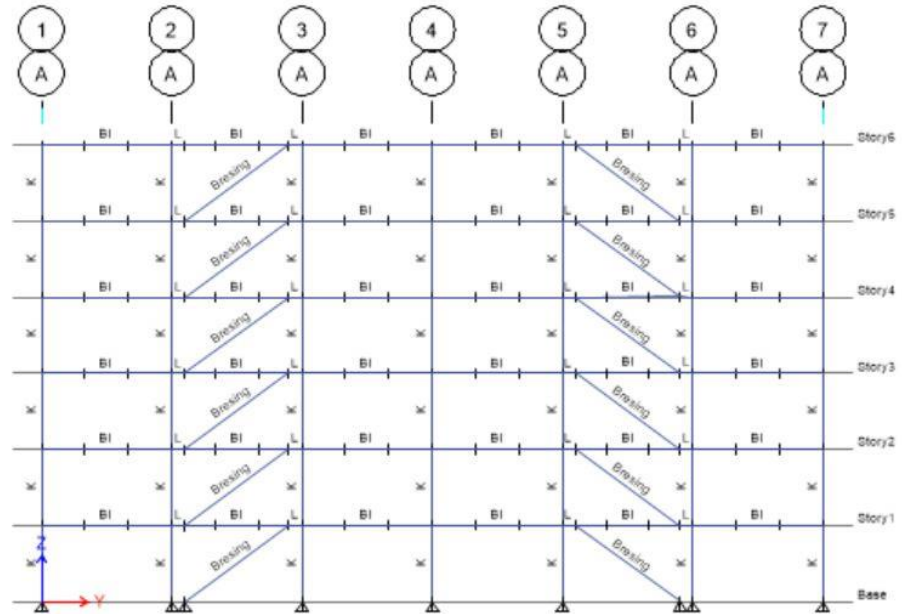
3 Elevation as A ,G, 1 & 7 dengan bresing *single link diagonal
